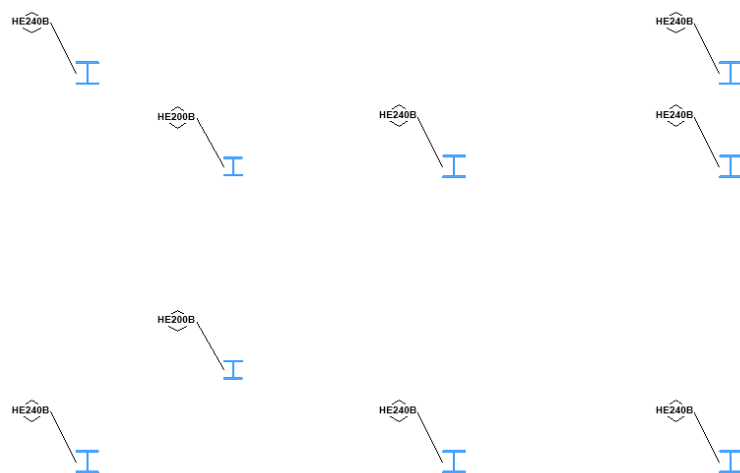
Disposición en planta de los pilares de las torres de embarque.
